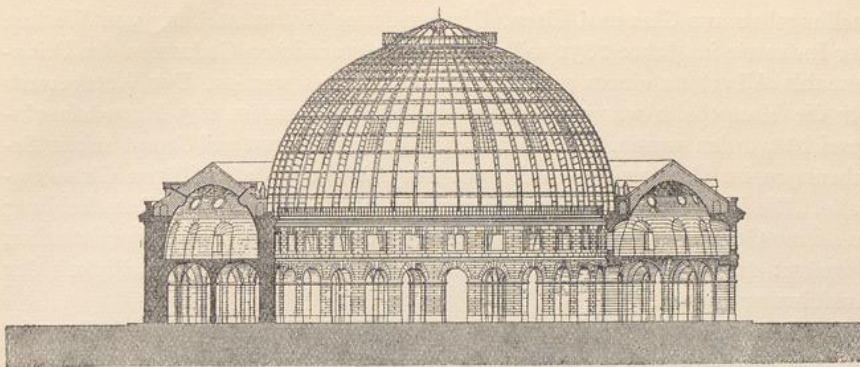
Getreidehalle, Paris 1811. Dachkonstruktion
